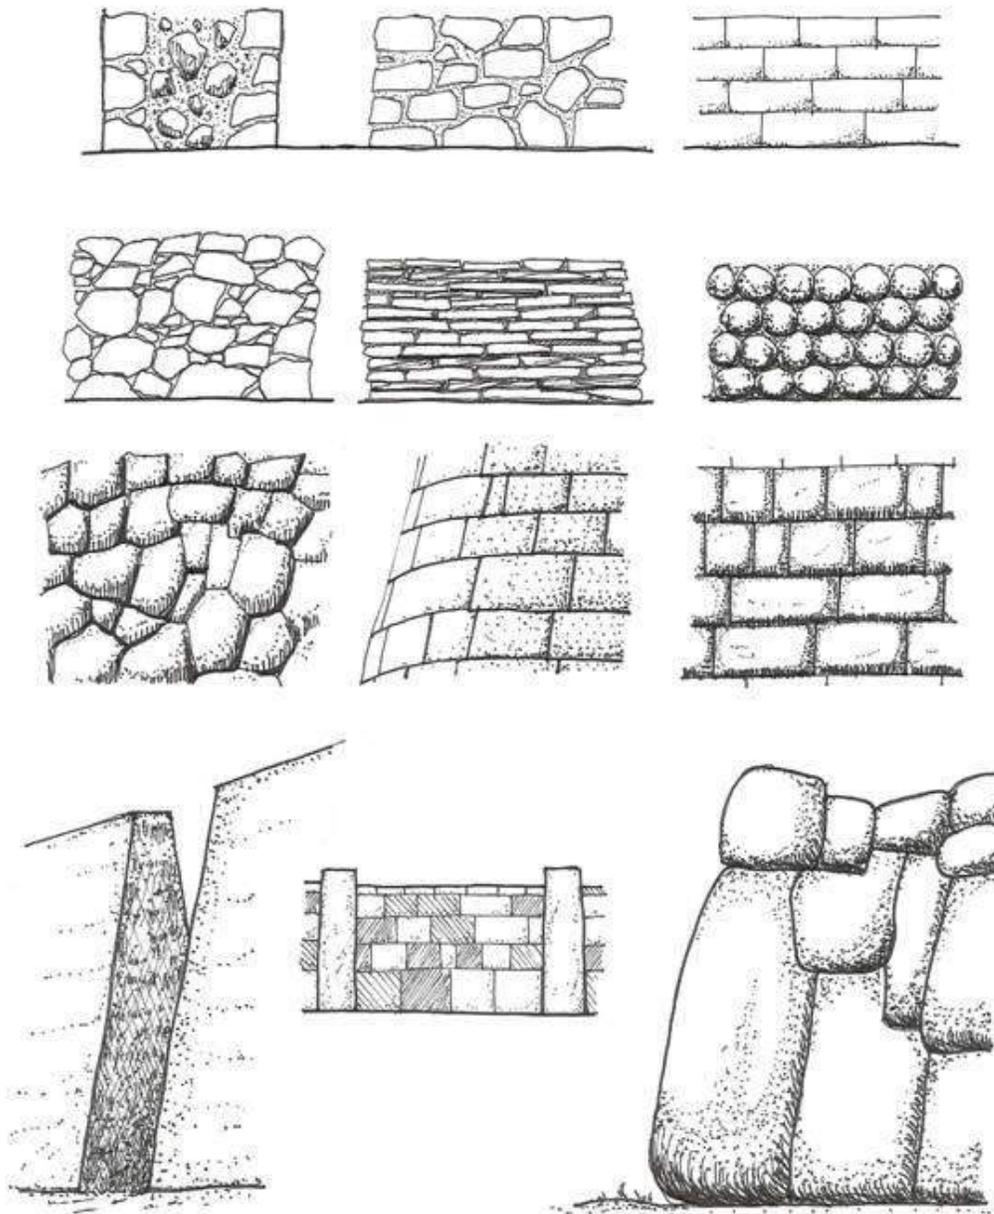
Muros. Arriba: corte y vista de muro doble, y vista de muro de adobes. Segunda fila: muro de pirca con piedra común, muro de pirca con piedra laja, muro de adobe cónico. Tercera fila: Variantes de tratamiento de la piedra en muros inkas. Abajo, de izquierda a derecha: muralla de Chan Chan, muro con contrafuertes del Kalasasaya de Tiwanaku, y muralla de Sachahuaman.
